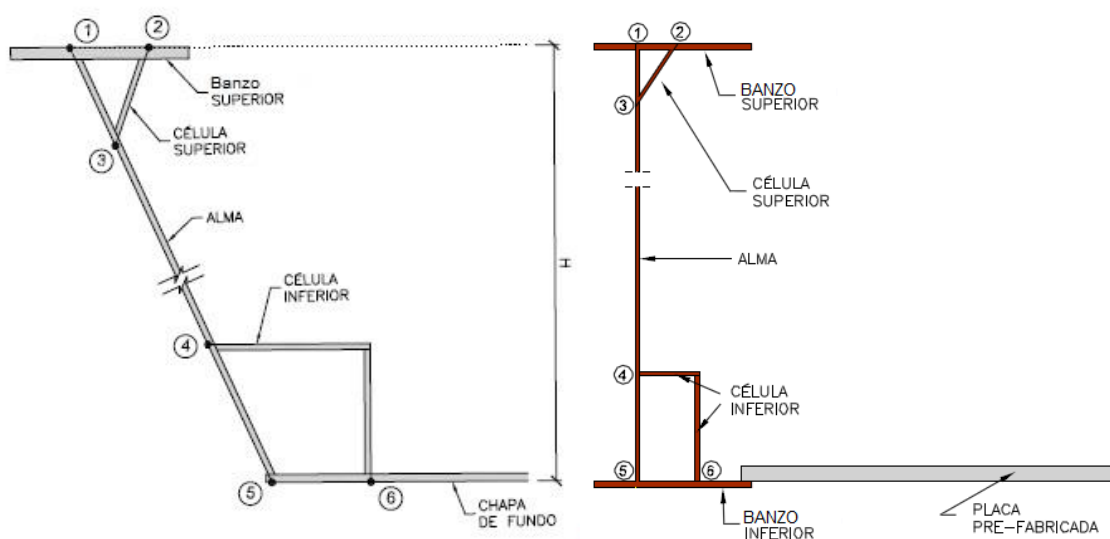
Representação das ligações soldadas longitudinais nas secções transversais (caixão e bi-viga)
